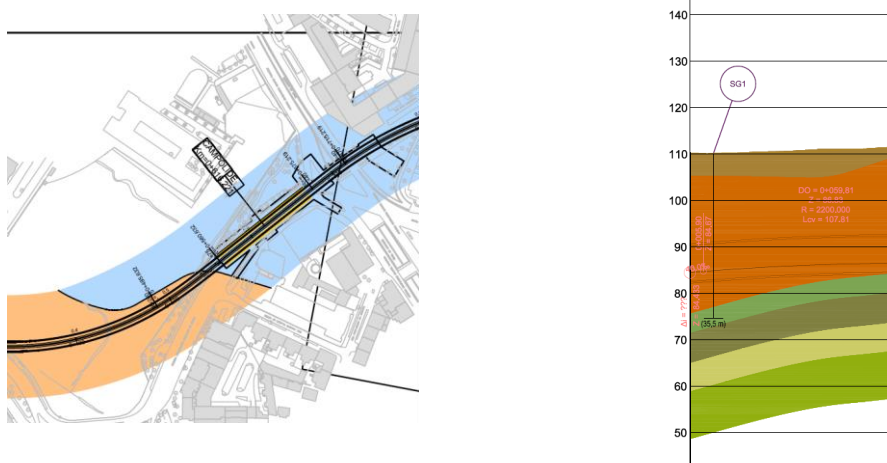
Planta e perfil longitudinal – Geologia / Geotecnia
